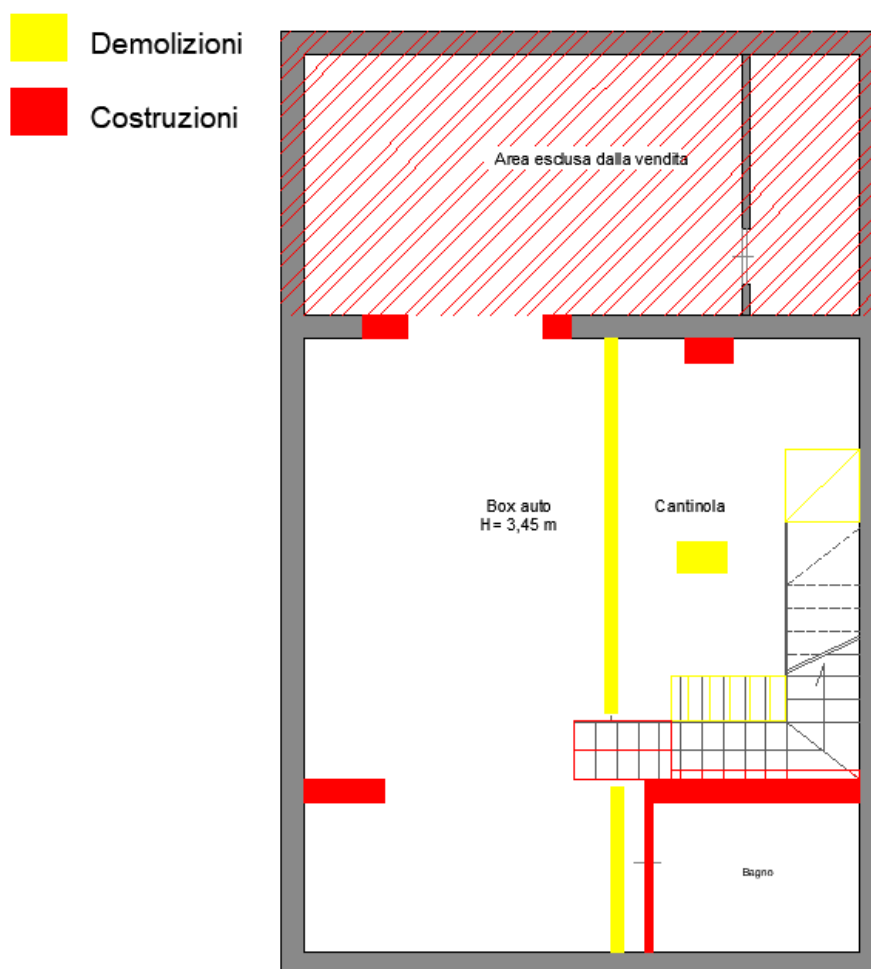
Confronto Edilizio con Variante alla C.E. n. 40949/2005 – Pianta Piano Seminterrato
